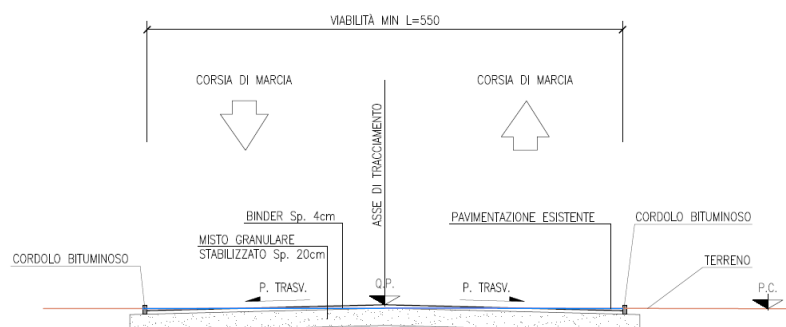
Sezione tipo nel tratto di rifacimento della pavimentazione
